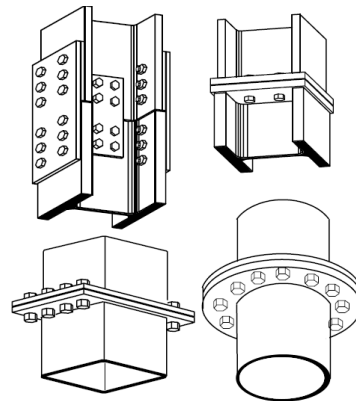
Emenda de pilares (SCI/BCSA, *Joints in steel construction - simple connections.*, 2006)
